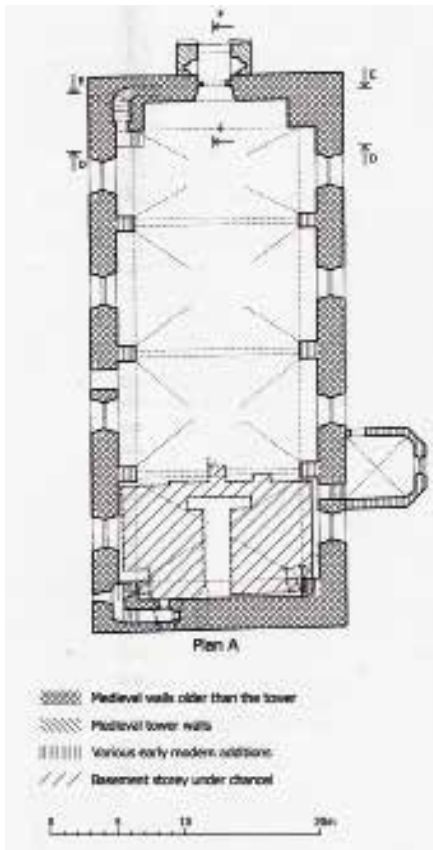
Der Grundriss der Kirche in Jõhvi. Kadakas, "Jõhvi Church", 94
